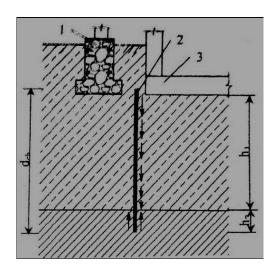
Разделительная стена: 1 - фундамент существующего здания; 2 - разделительноя стена; 3 - фундамент нового здания
